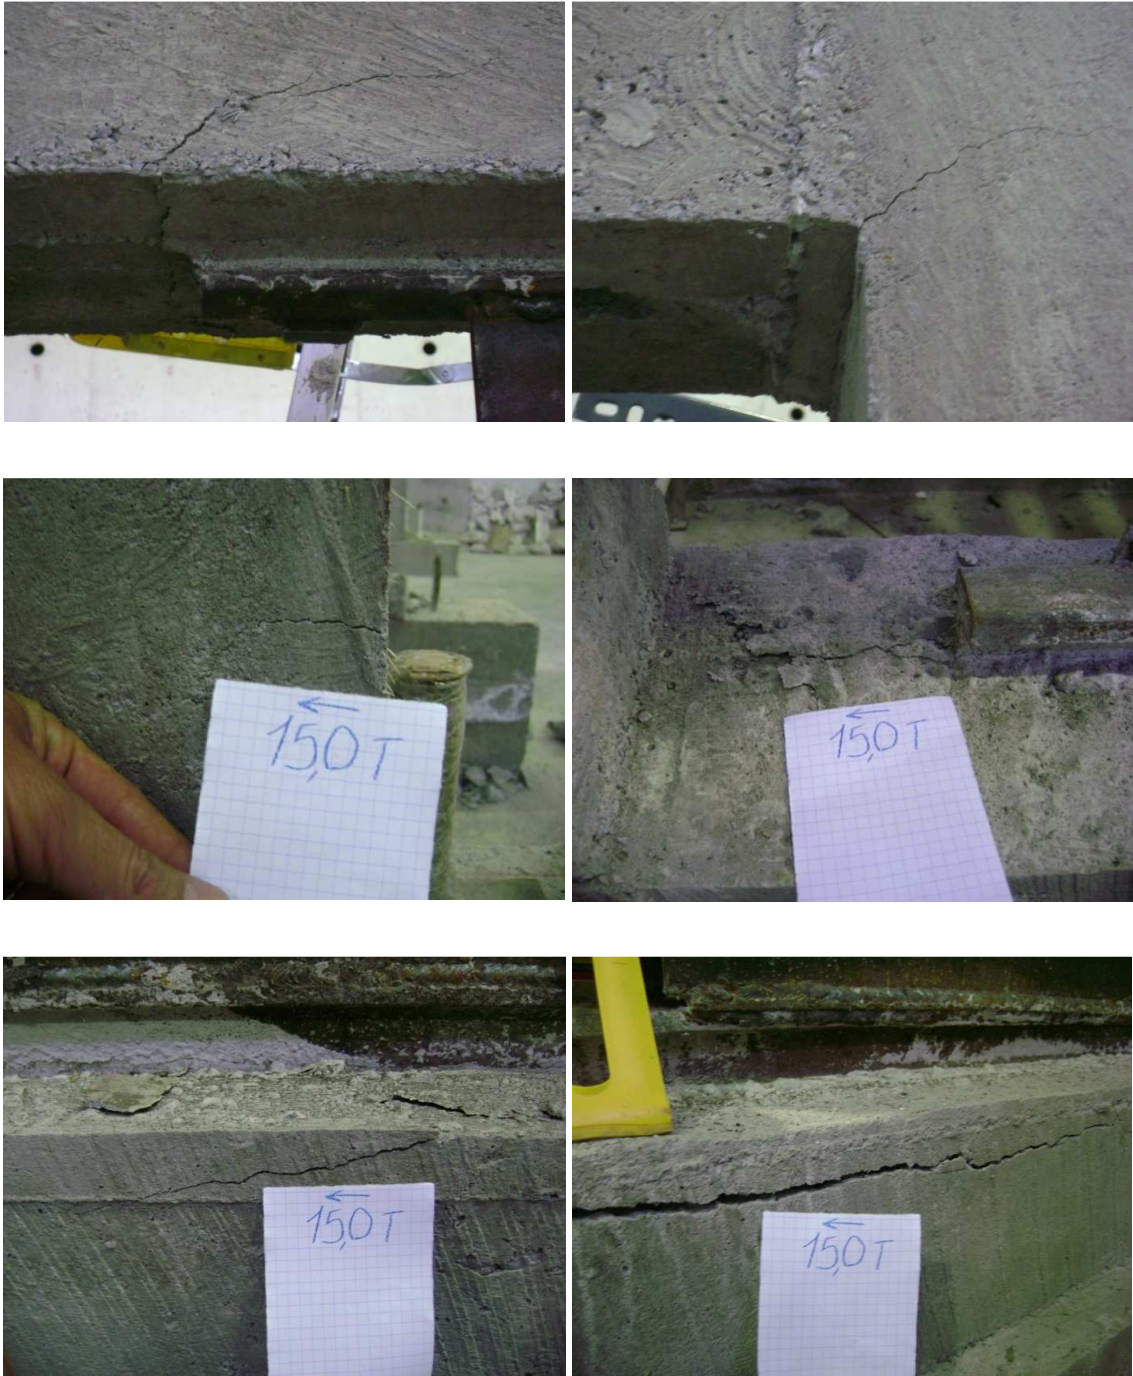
Fisuras y grietas en el pórtico PVEW. Carga -15.0Ton.
